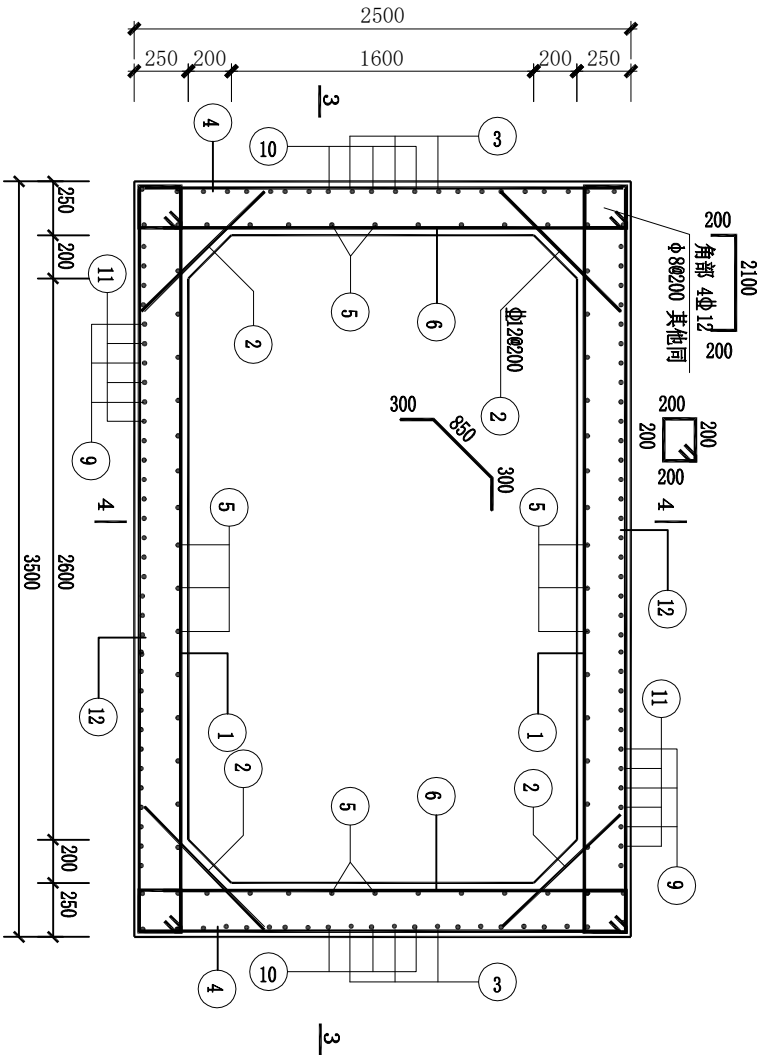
[3.0×2.0×1.9钢筋混凝土直线电缆井 (E-1-13) (一)]
